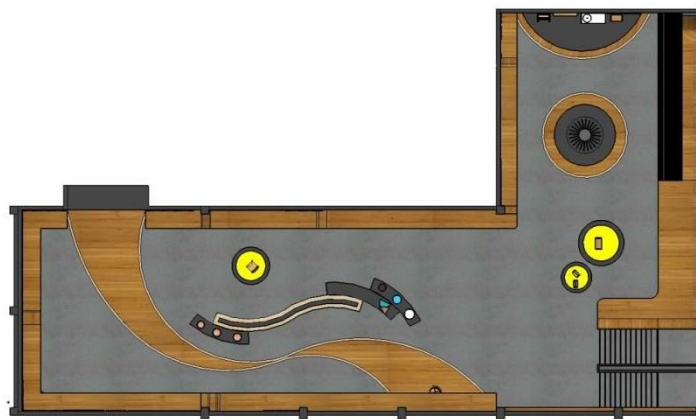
Denah Khusus Showroom Lantai 1
